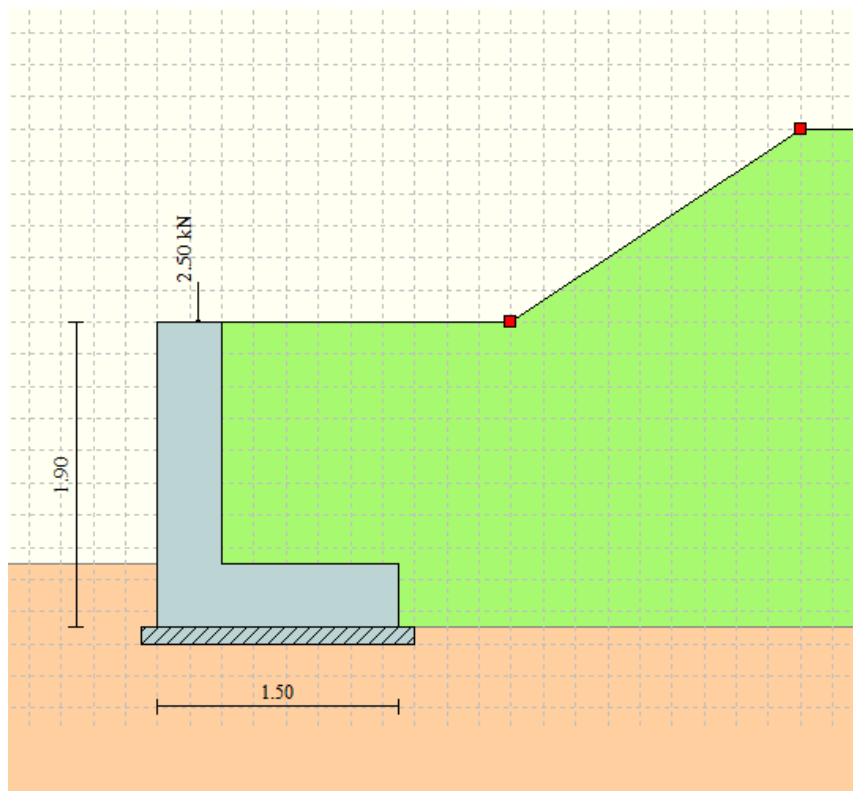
Applicazione dei carichi: Peso parapetto
